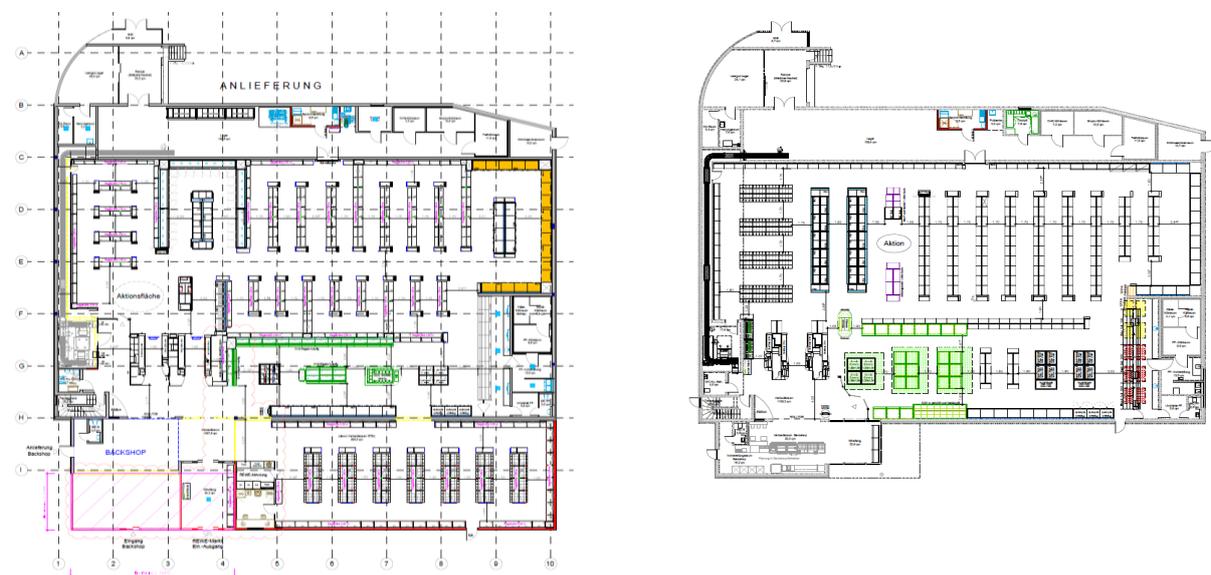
Grundriss Planungsentwurf (links) und Bestand (rechts)
